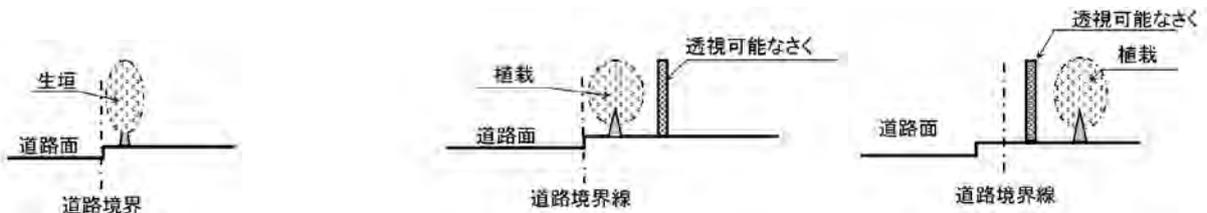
(8) 道路断面図(地区計画による植栽誘導のイメージ)
